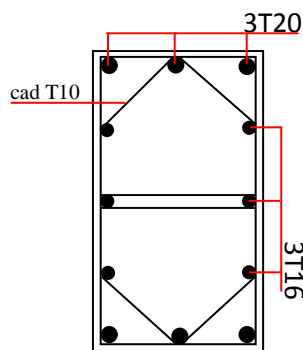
Dessin de ferrailages des sections des poteaux.
